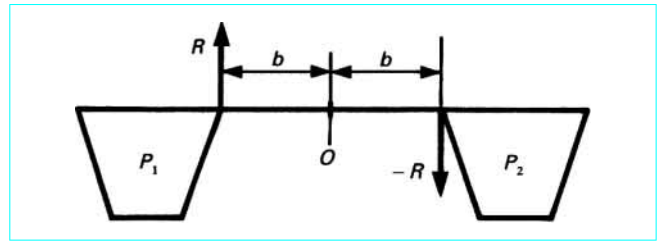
Coupe transversale d'un pont constitué de deux poutres
